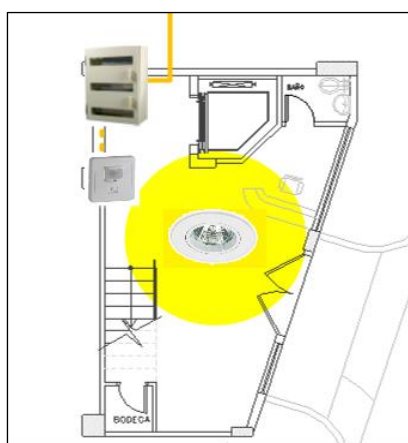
Ubicación de equipos para control de iluminación en planta baja
